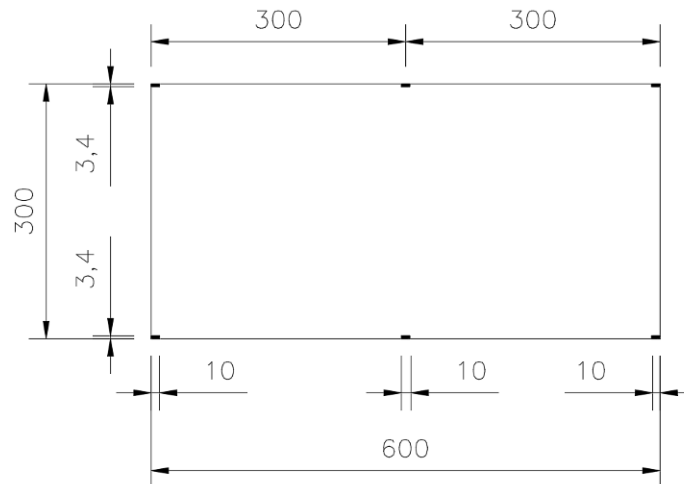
Projeto estrutural: Planta do Pav. Tipo. Dimensões: milímetros
